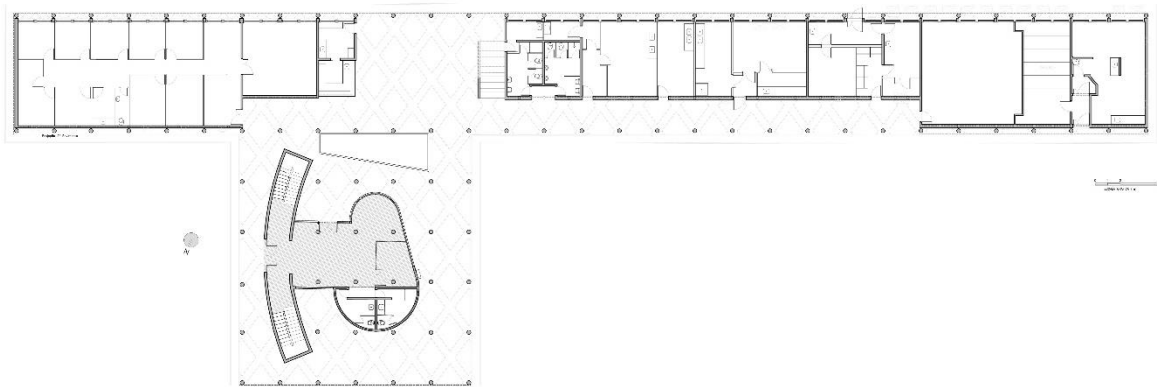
Pavilhão Arthur Neiva: planta do 1o pavimento, 2016. Fonte : DPH/COC/Fiocruz
